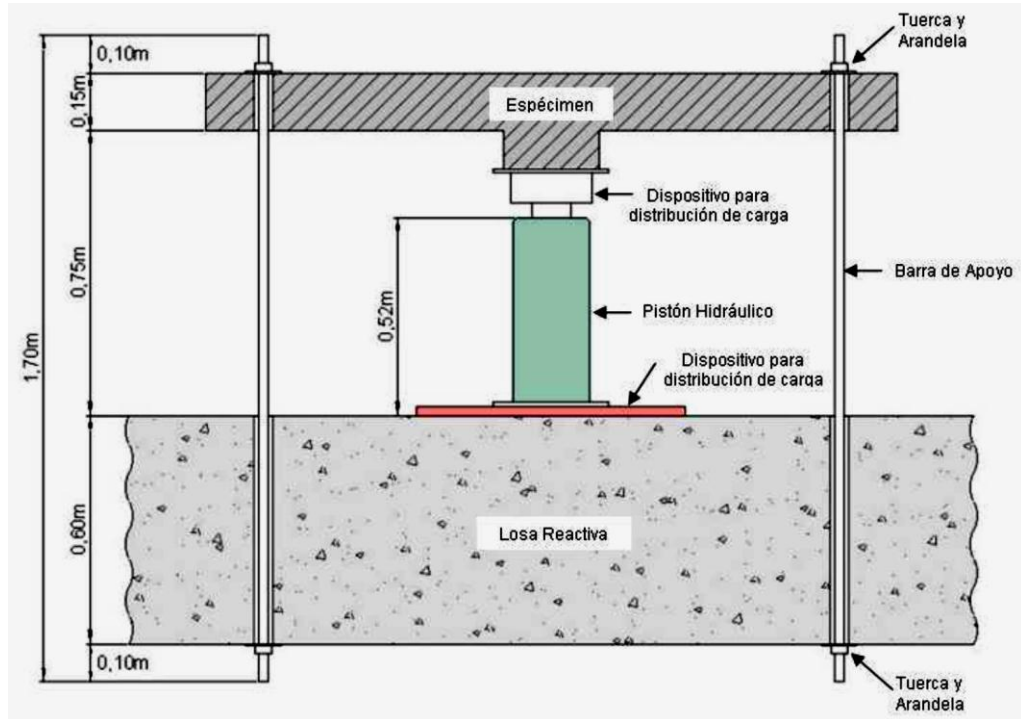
d.2-1) Esquema e imagen de ensayo de falla por penetración en losa de concreto armado
